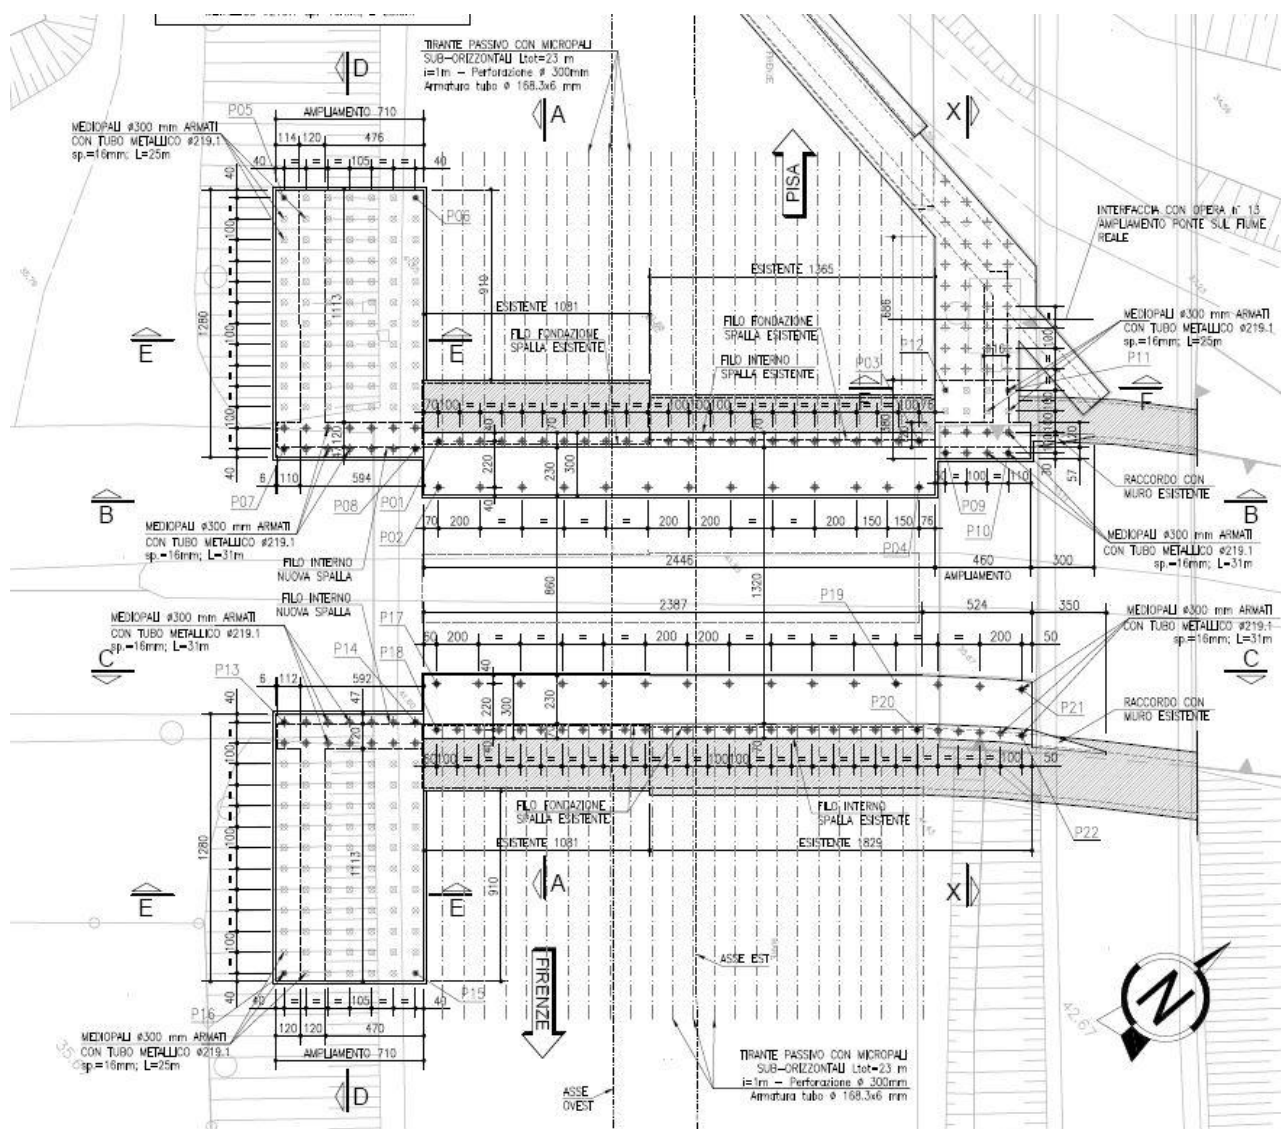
Planimetria di progetto opere di fondazione.
